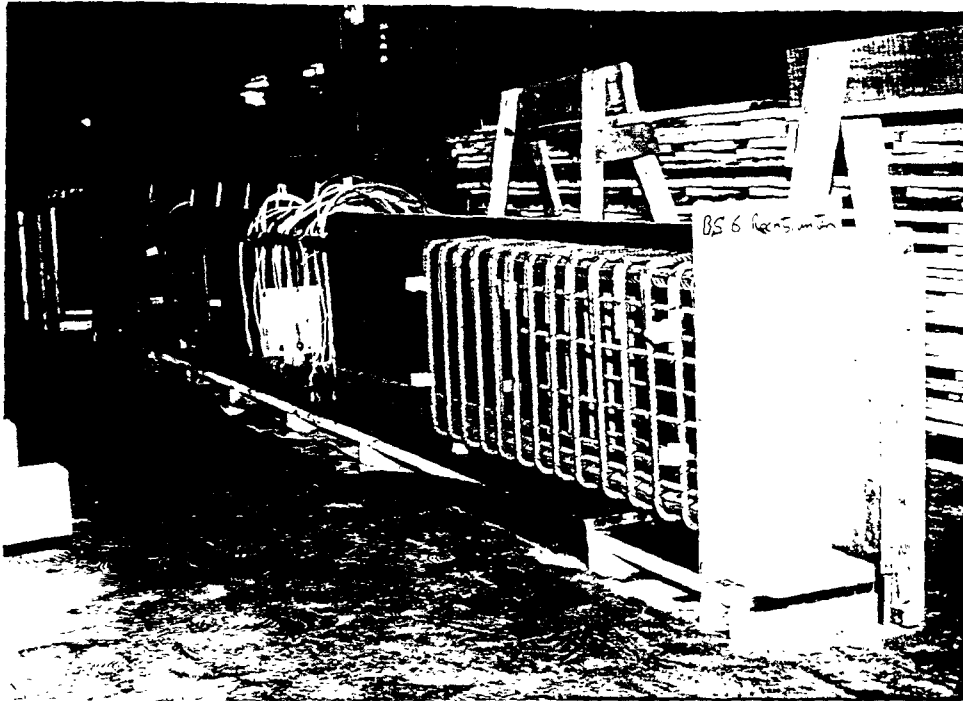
Bewehrungskorb und Schalung mit eingesetztem Bewehrungskorb der Versuchskörper
